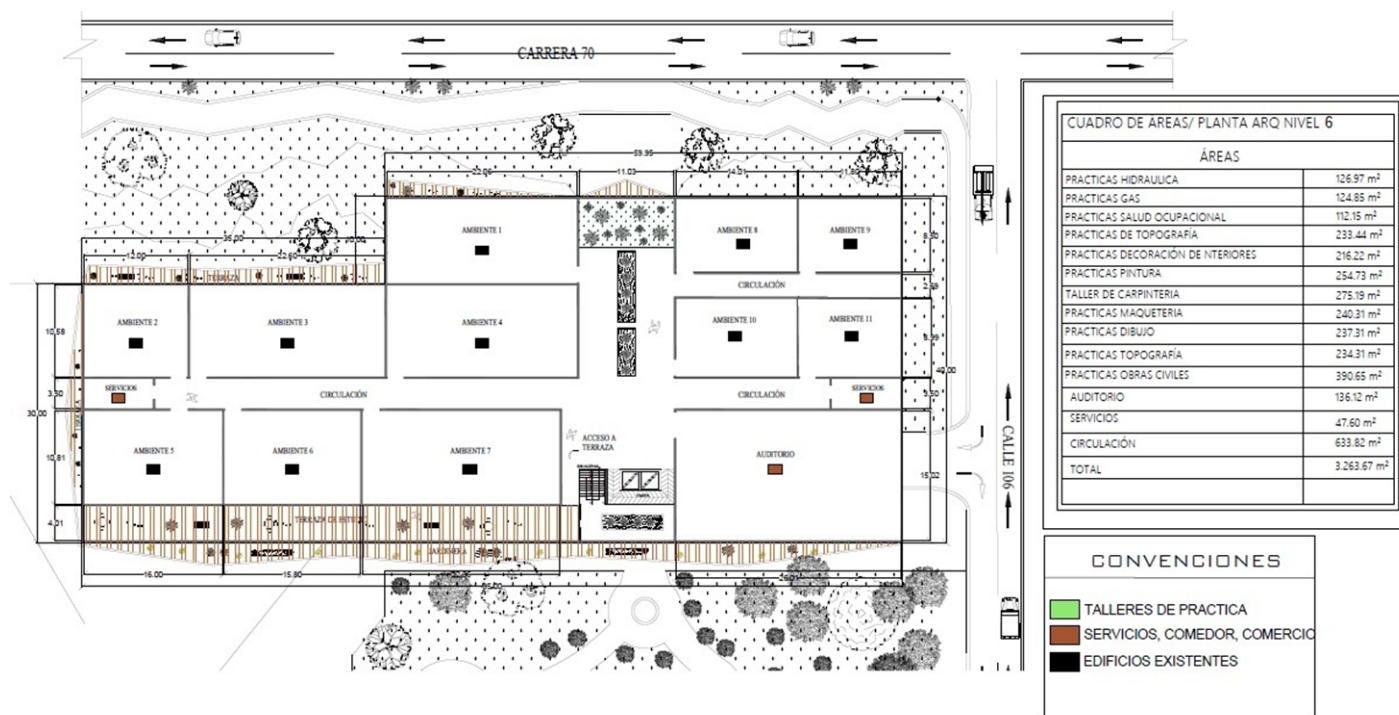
Diseño conceptual de la planta 6. Acá se ubican áreas de prácticas y talleres y un auditorio.
